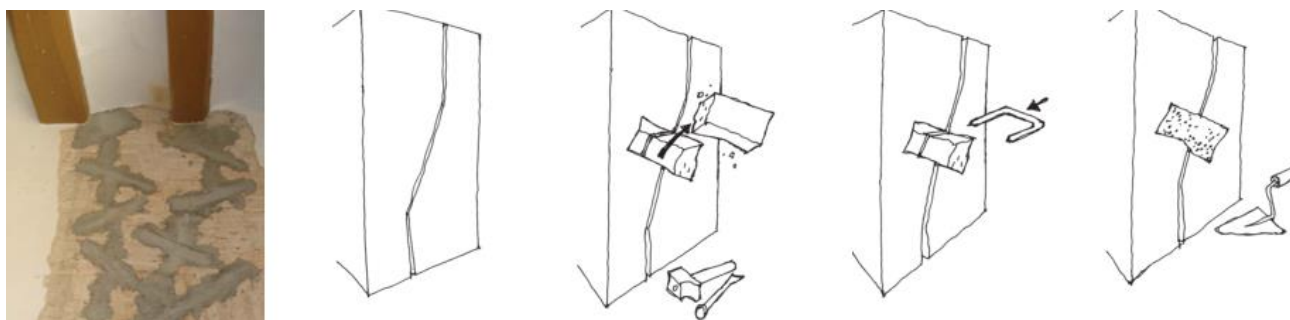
Exemplo de aplicação de peças metálicas para reabilitação de fissuras (“Herramienta 8,” n.d.)
